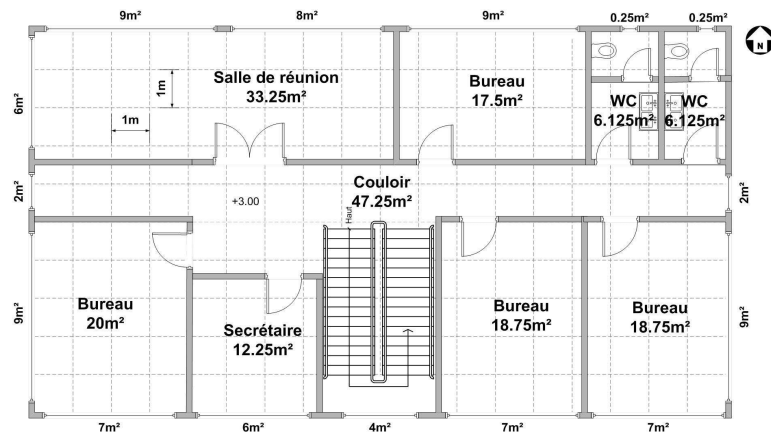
Plan du 1er étage du bâtiment Beethoven
